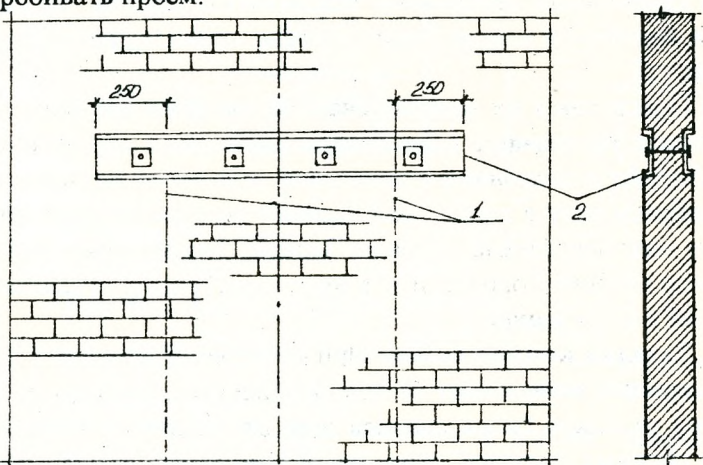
Схема закладки стальных балок перемычки при пробивке проемов в стенах.
